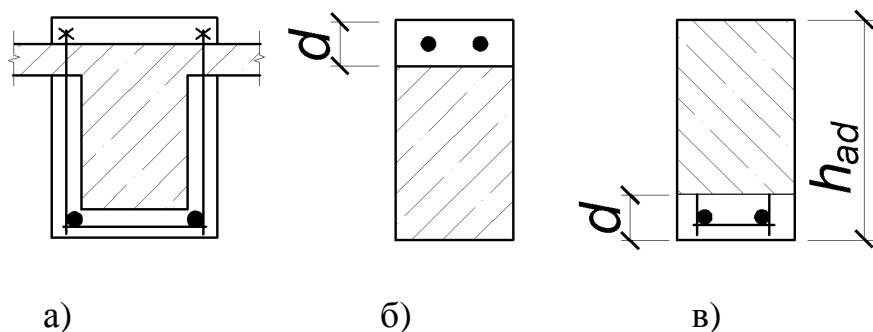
Підсилення балок нарощуванням перерізу:
